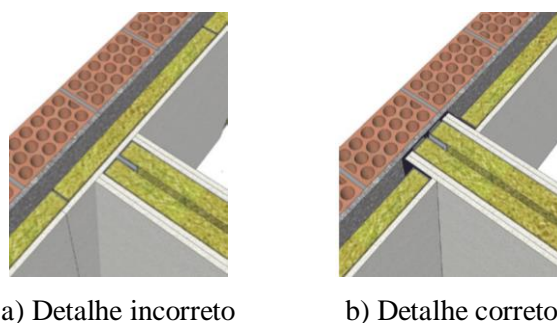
Ponto de ligação entre parede divisória de estrutura leve e parede em alvenaria de fachada. (COST, 2014)
